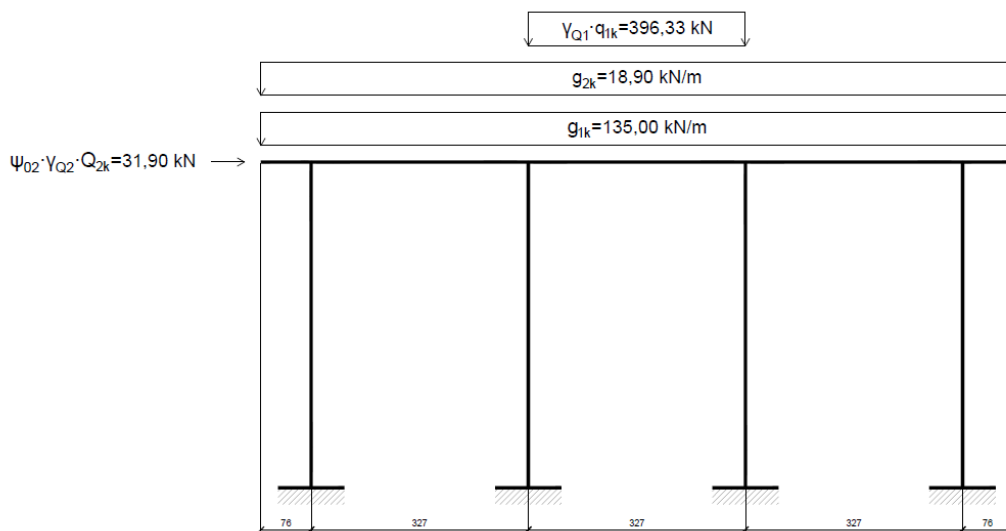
Schema statico della pila della US2 allo stato di progetto in combinazione SLU4.
